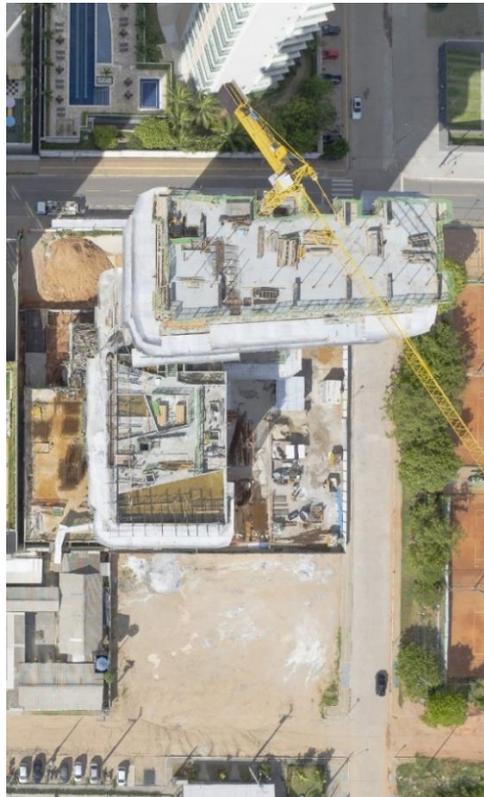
Fôrma 15ª Laje (12º Pavimento) - Fonte: Fornecido pela Construtora
